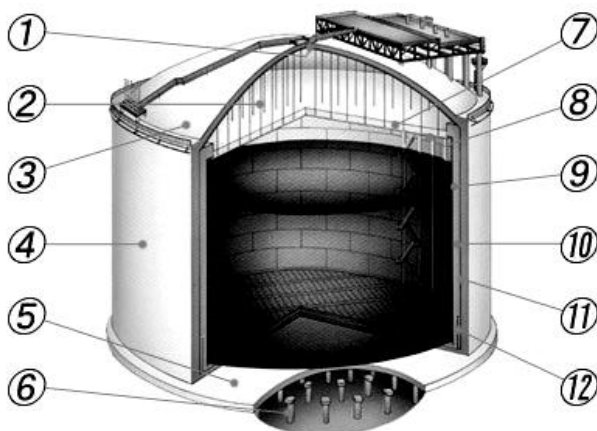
Железобетонный изотермический резервуар с замкнутой наружной оболочкой:
